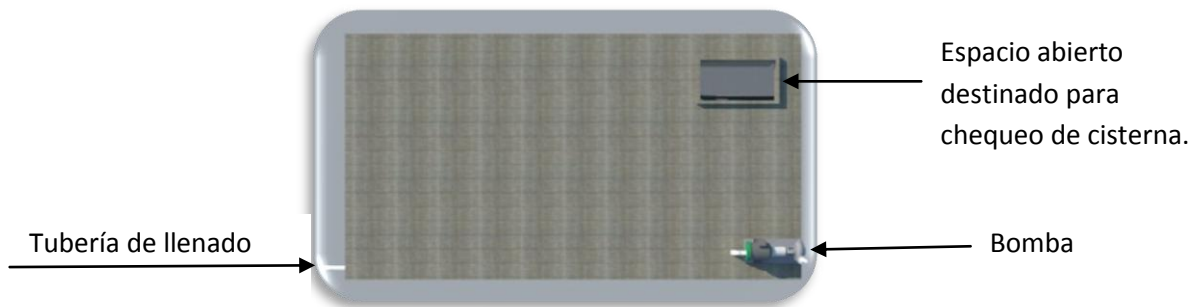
Planta de cisterna Fuente: Elaboración propia
